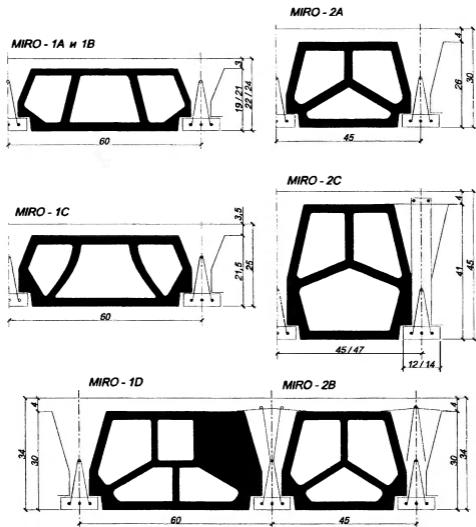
Пример устройства междуэтажного перекрытия с использованием вкладышей из легкого бетона и керамики, по железобетонным балкам-доскам (тип MIRO)
